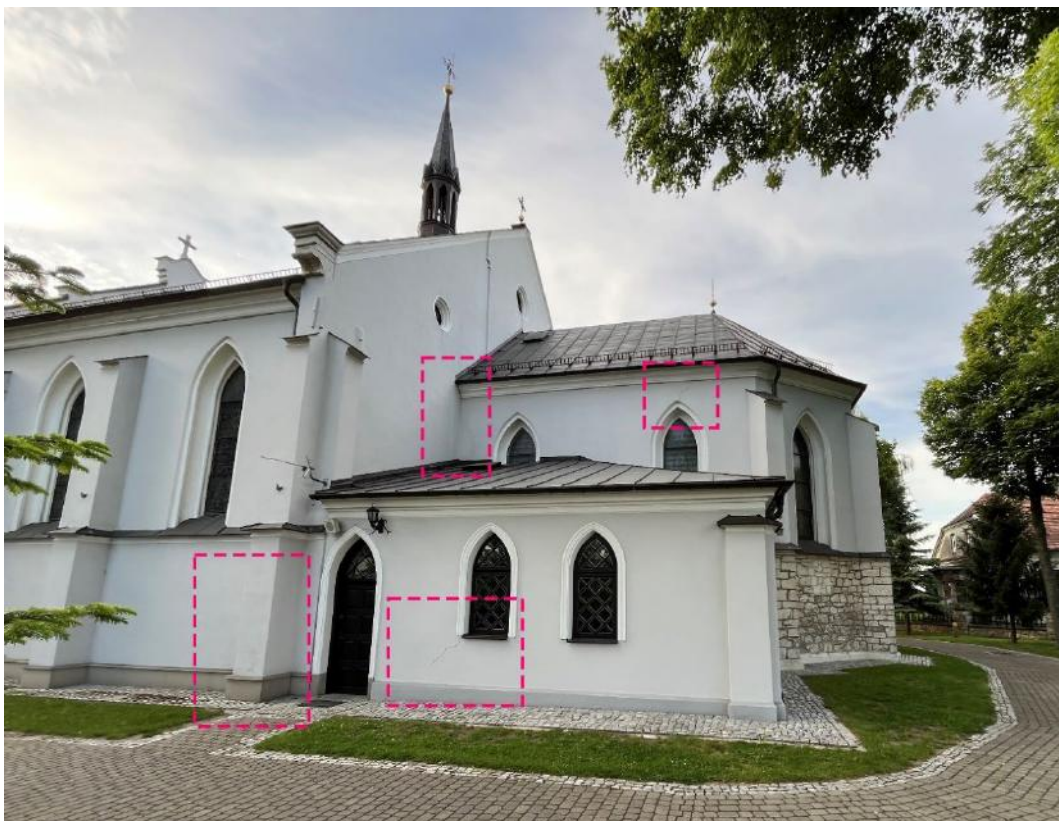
Zniszczenia na elewacji frontowej budynku kościoła (elewacja zachodnia).
